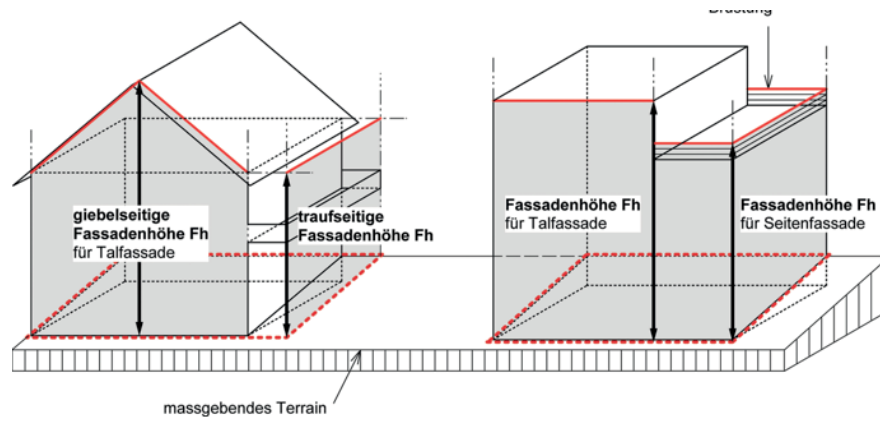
Die traufseitige Fassadenhöhe ist bei jedem Punkt der massgebenden Fassade einzuhalten.
